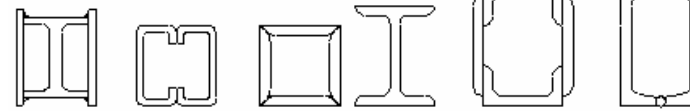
Fuente: instructivo electropanel, empresa Monolit
